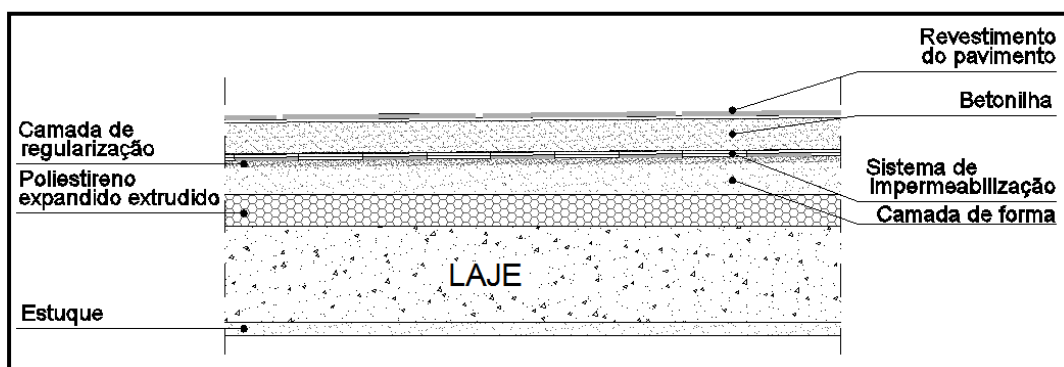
Pormenor da cobertura horizontal acessível em laje maciça, em corte (COB01)
